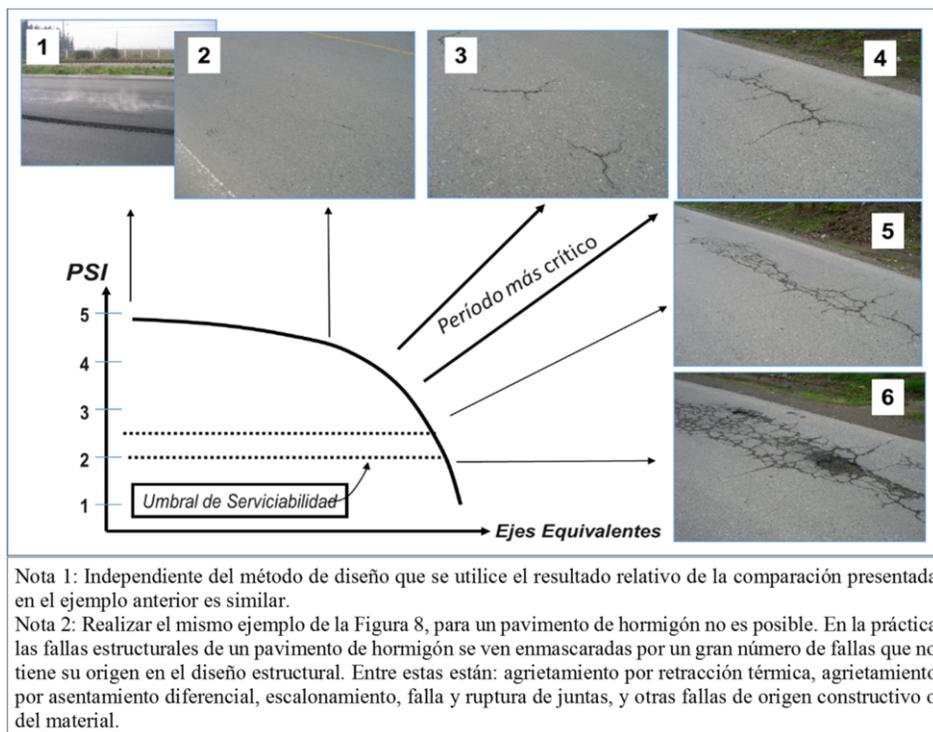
Ejemplo modelo de deterioro estructural pavimento asfáltico.
